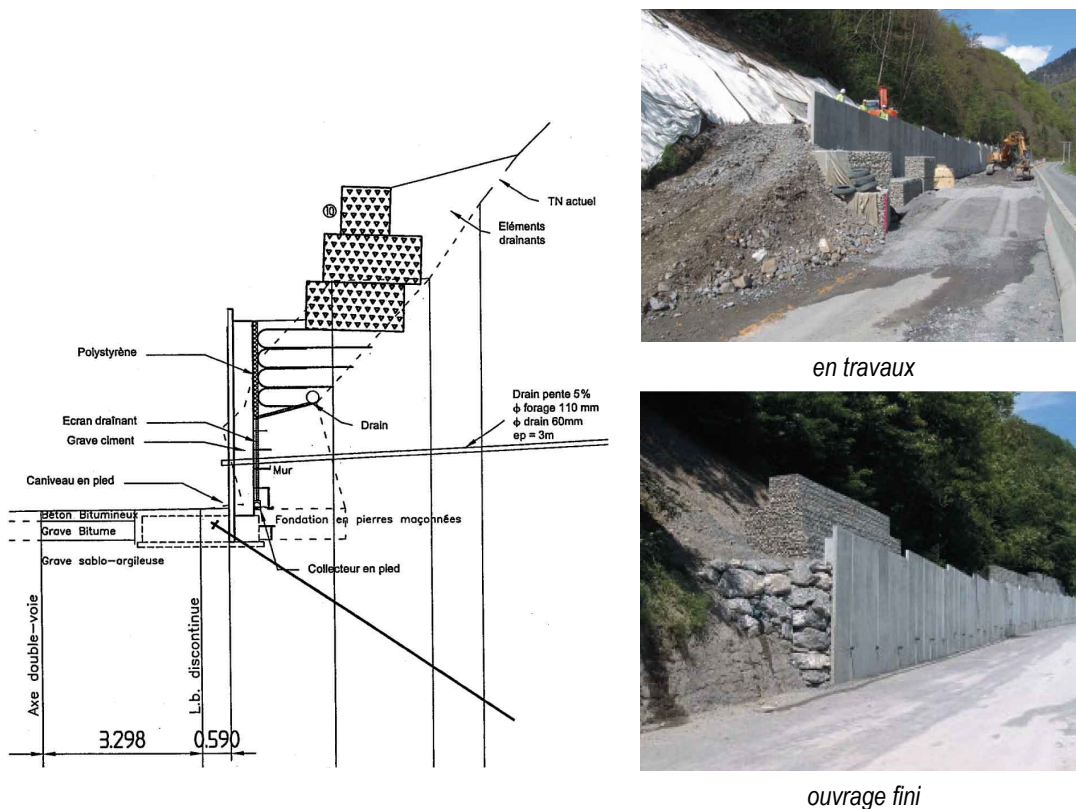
L'ouvrage de renforcement du glissement de talus amont de la RN 212
